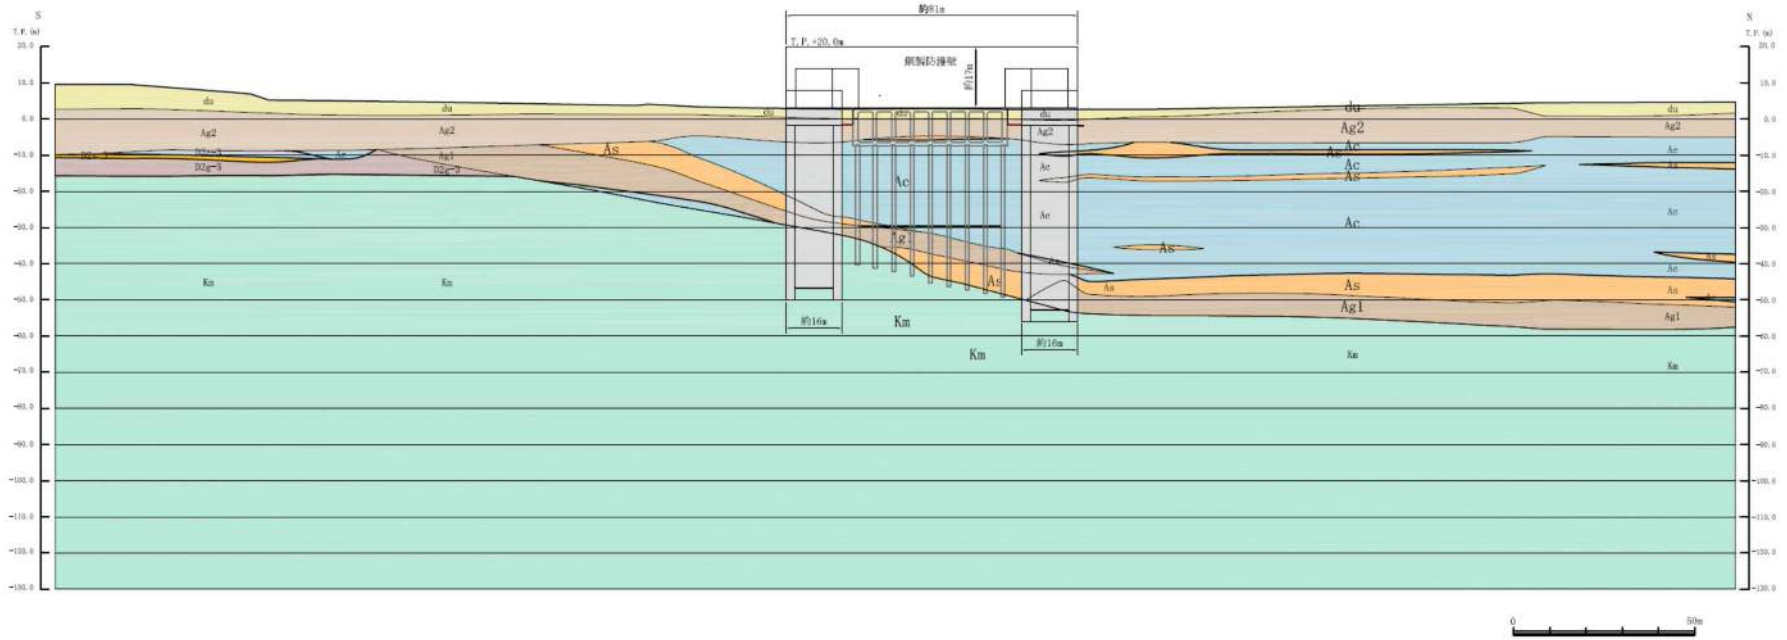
(1) 鋼製防護壁評価対象断面図 (①-①断面)
